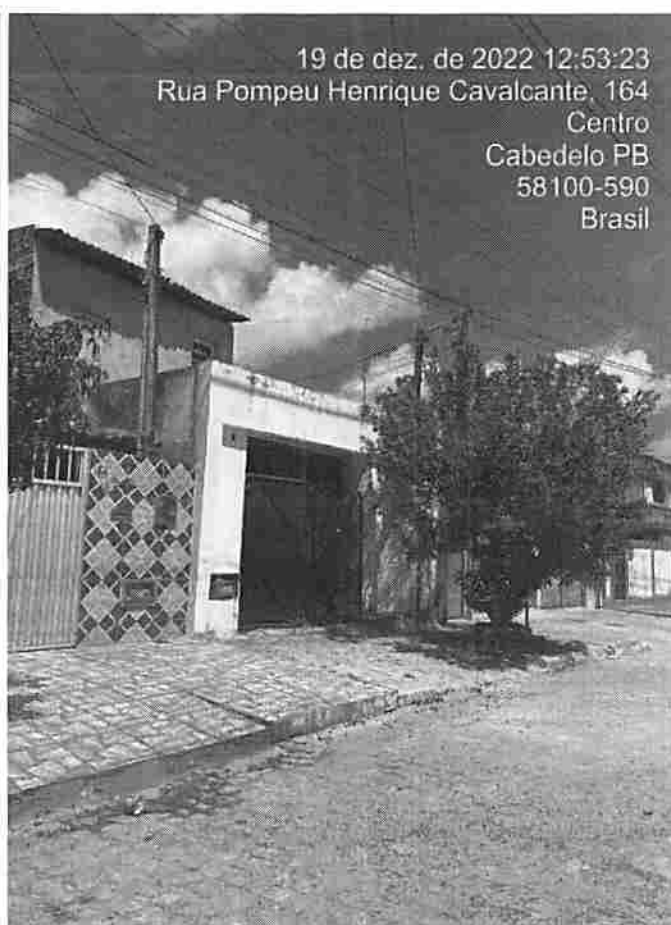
a 08 - Rua Pompeu Henrique Cavalcante, atualmente com pavimento em paralelepípedo.
